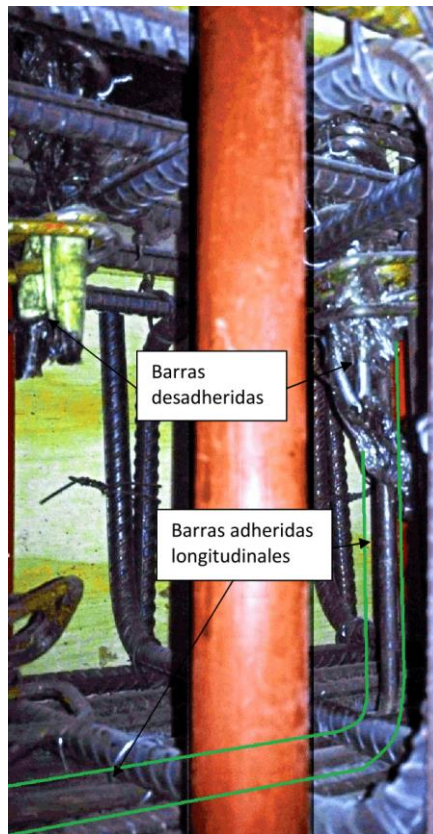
Instalación de Armadura Longitudinal en la Fundación.
